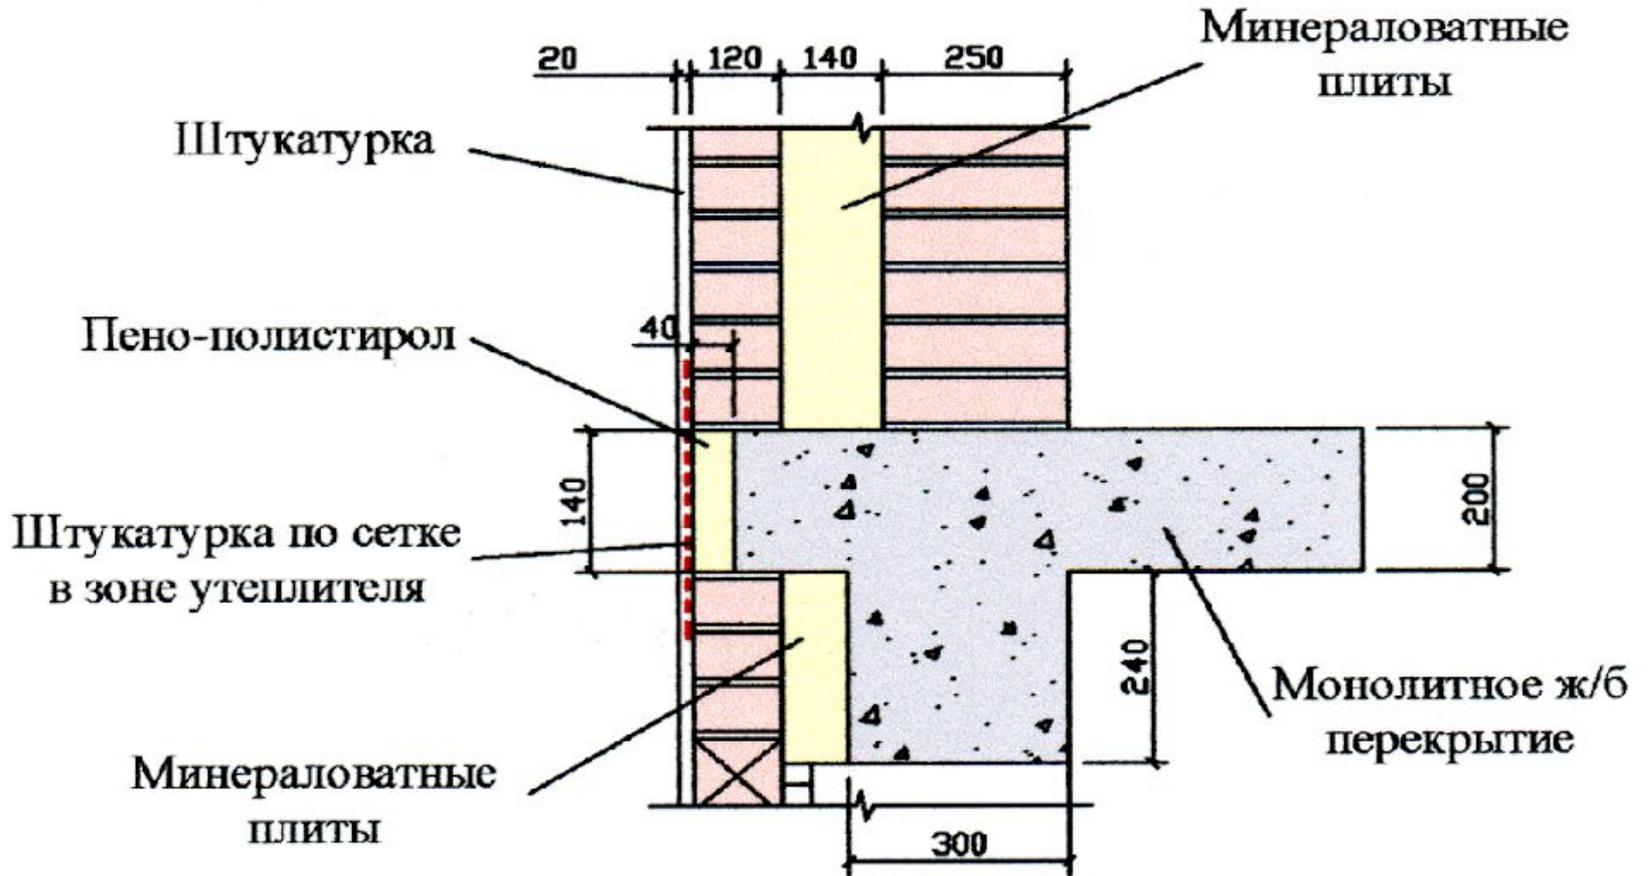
Узел сопряжения лицевого слоя кладки с плитой перекрытия.
